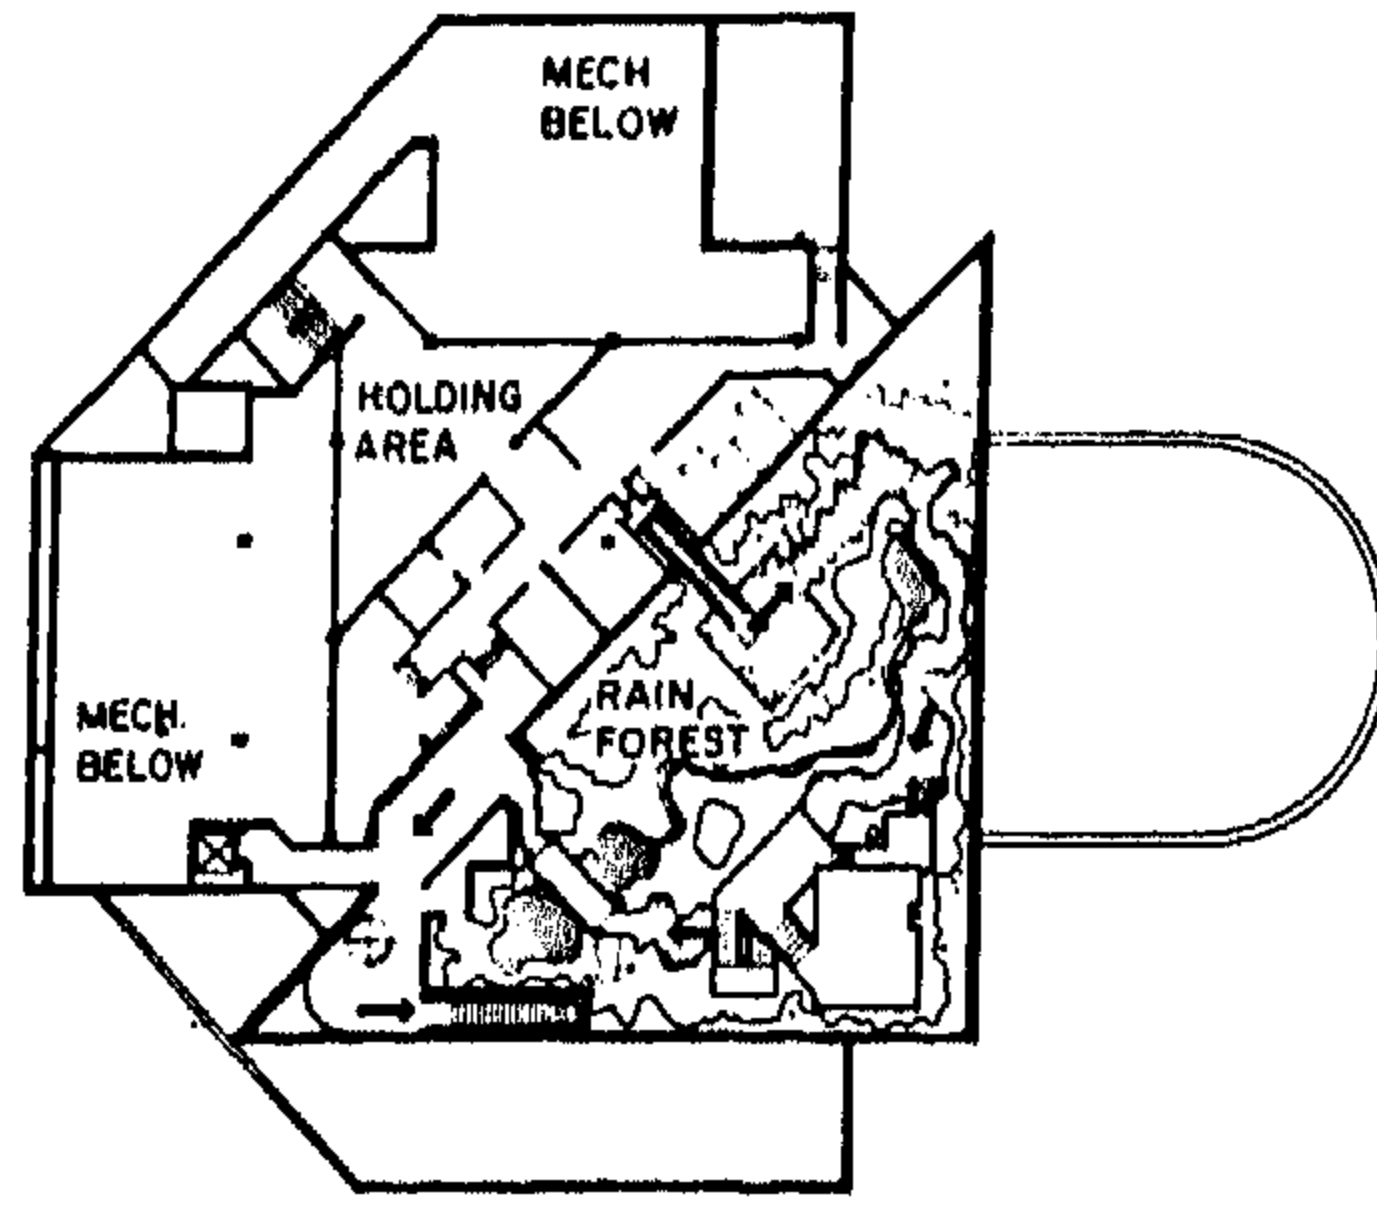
مسقط أفقي الدور الأرضي
